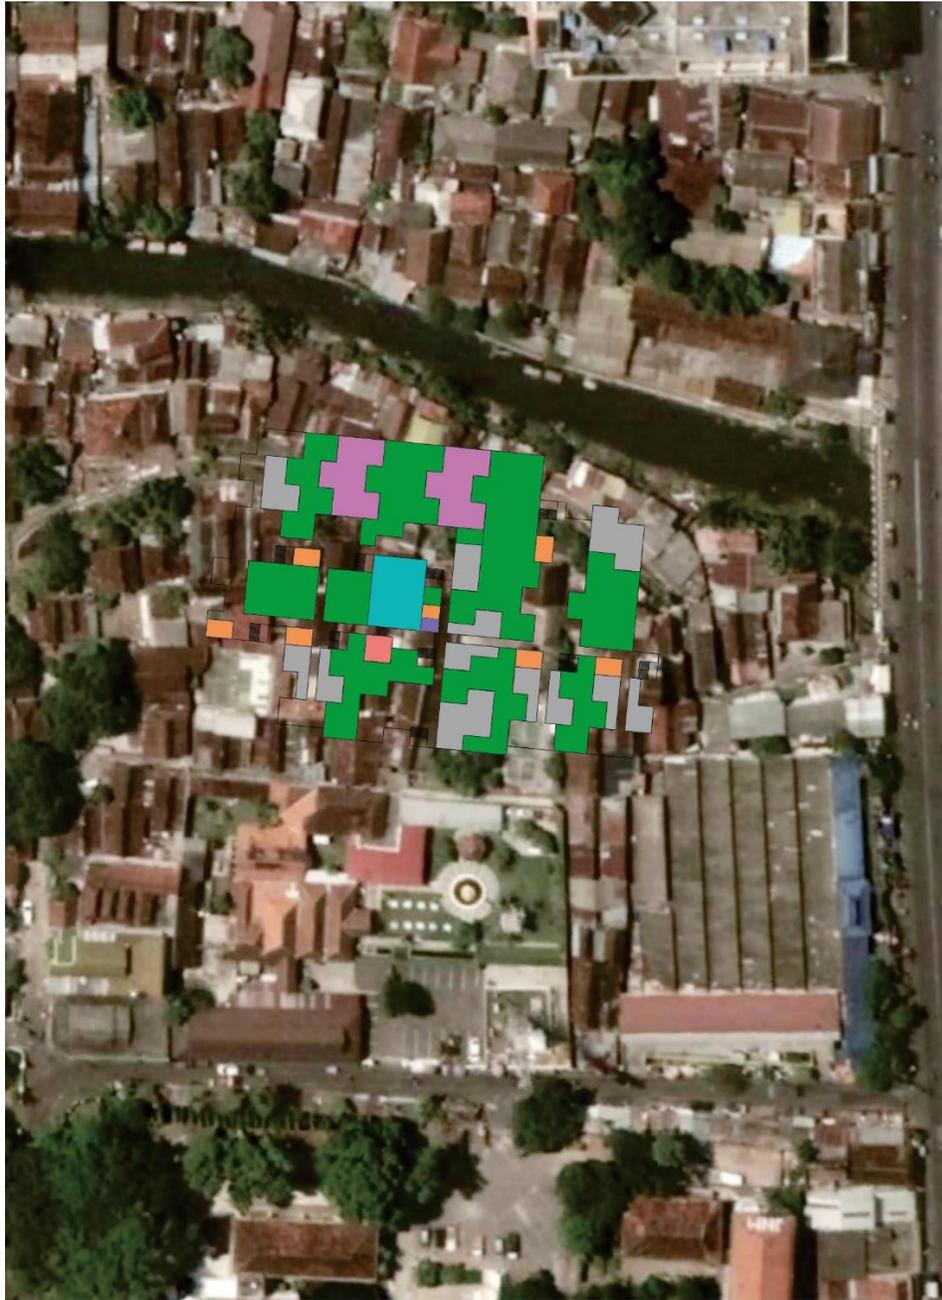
23 Rancangan Skematik Layout Masa Bangunan
